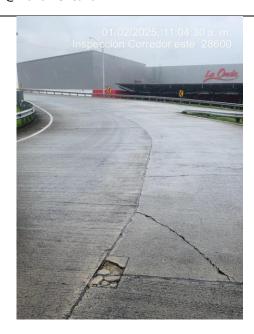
Se observa fallas en bloque de pavimento rígido en Foto N°16: Se evidencia losas fracturada en el intercambiador vial Panamericana
